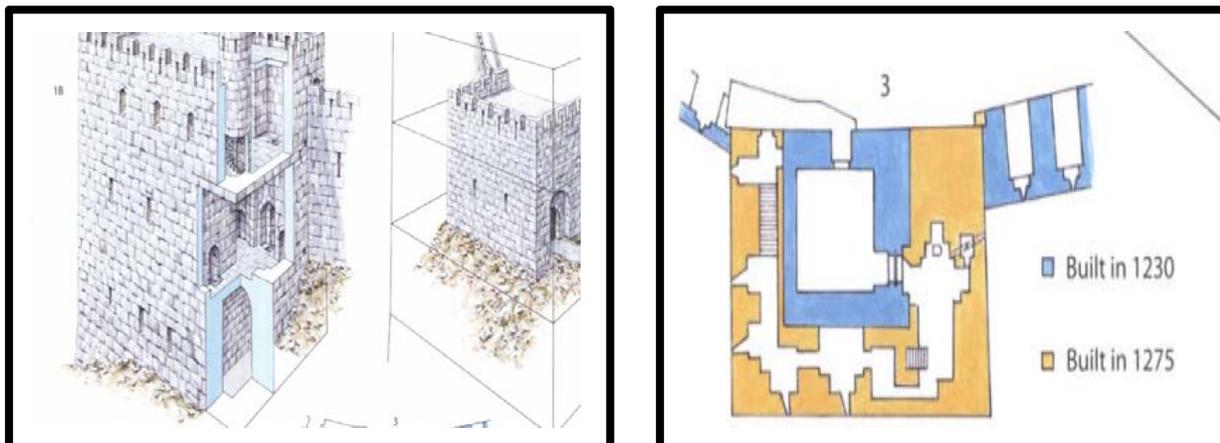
Plan et coupe de la Tour nord-ouest de la Qalaa de Bilik.
